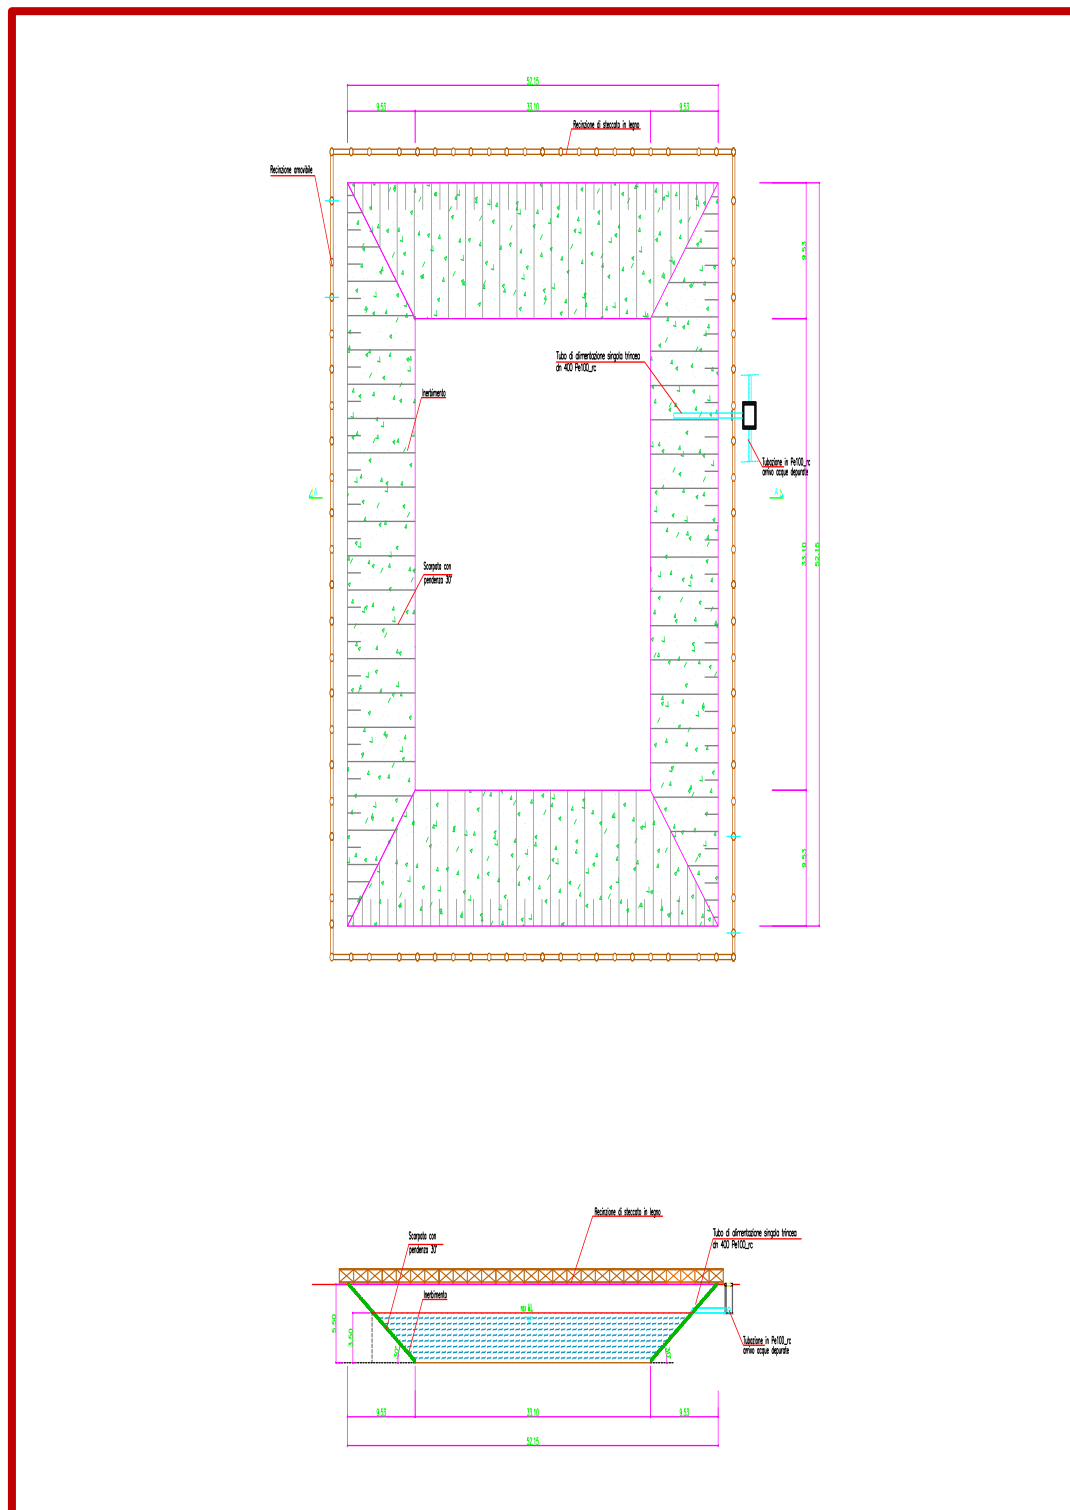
Pianta e Sezione tipo delle nuove trincee drenanti
